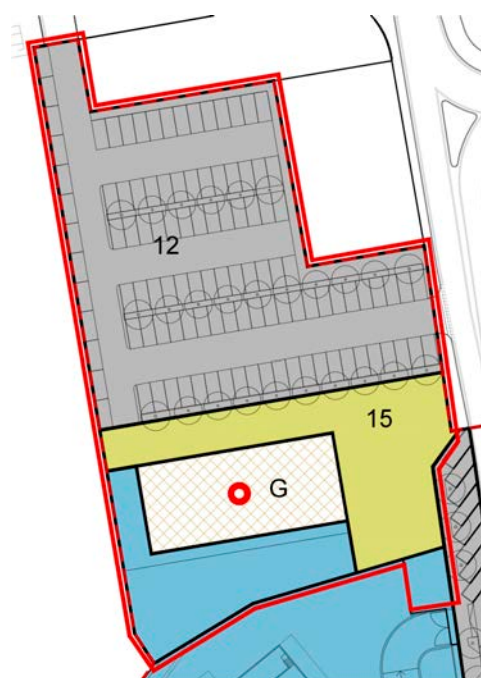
| Dettaglio del Lotto 6 con inserimento dell'asilo/struttura polivalente.
